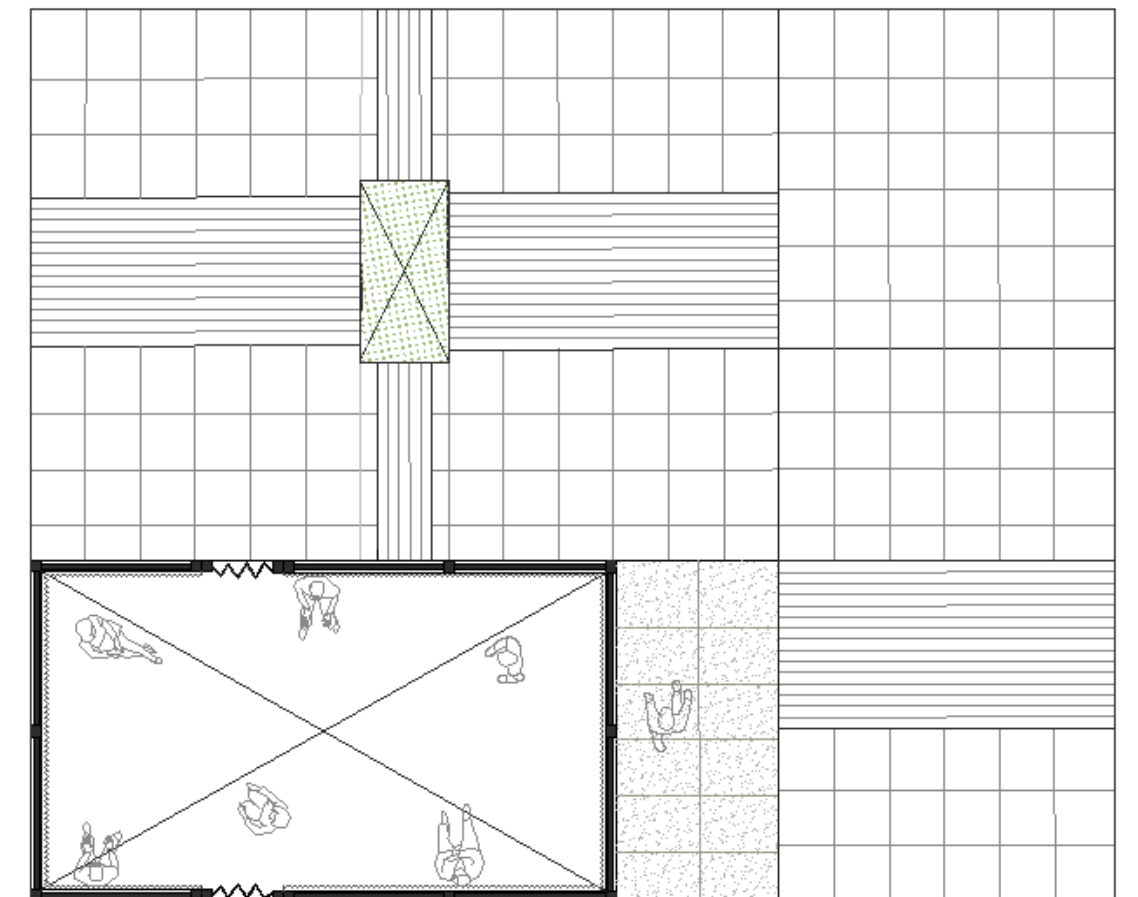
Planta do Pé-direito. Escala 1 | 100.
